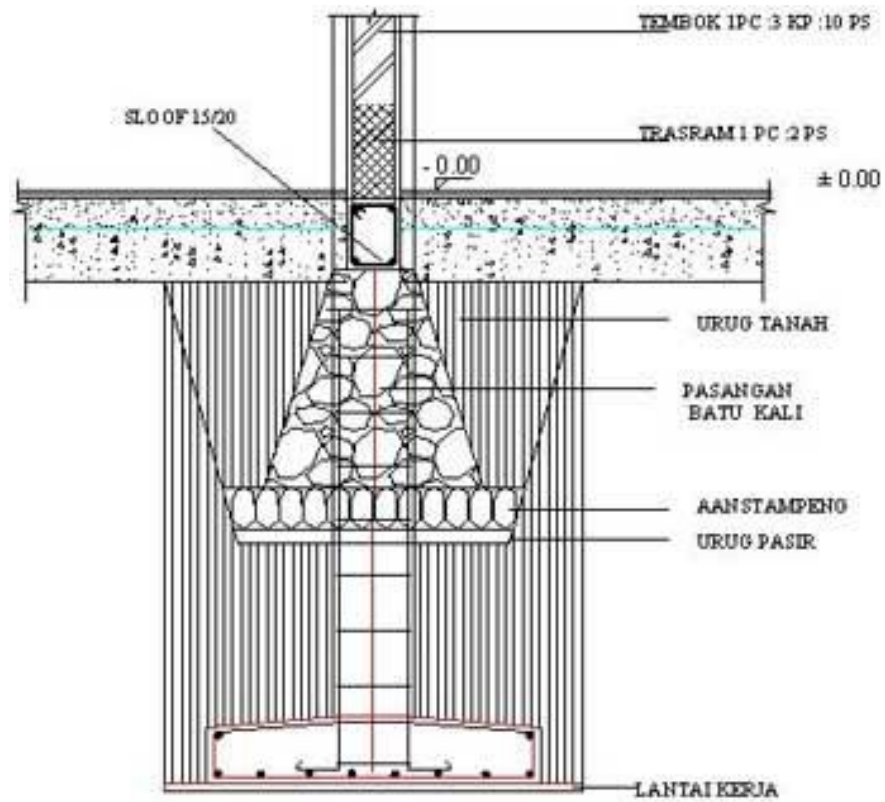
Rencana Pondasi Rumah Tinggal Tipe d
